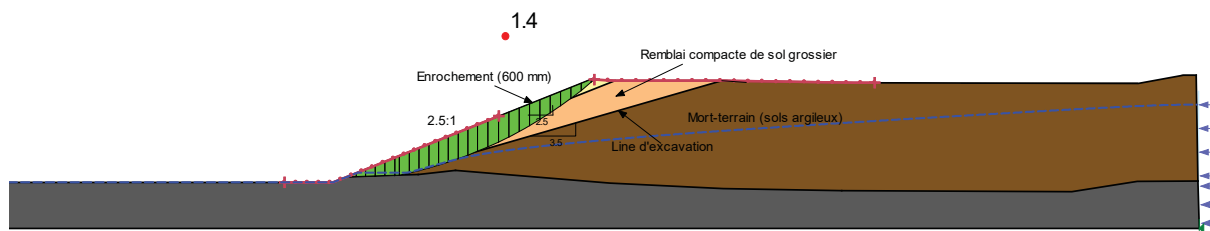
Stabilité pseudo statique, pente d'excavation 3,5H:1V et pente après le remblayage 2,5H:1V, excavation dans des sols argileux
